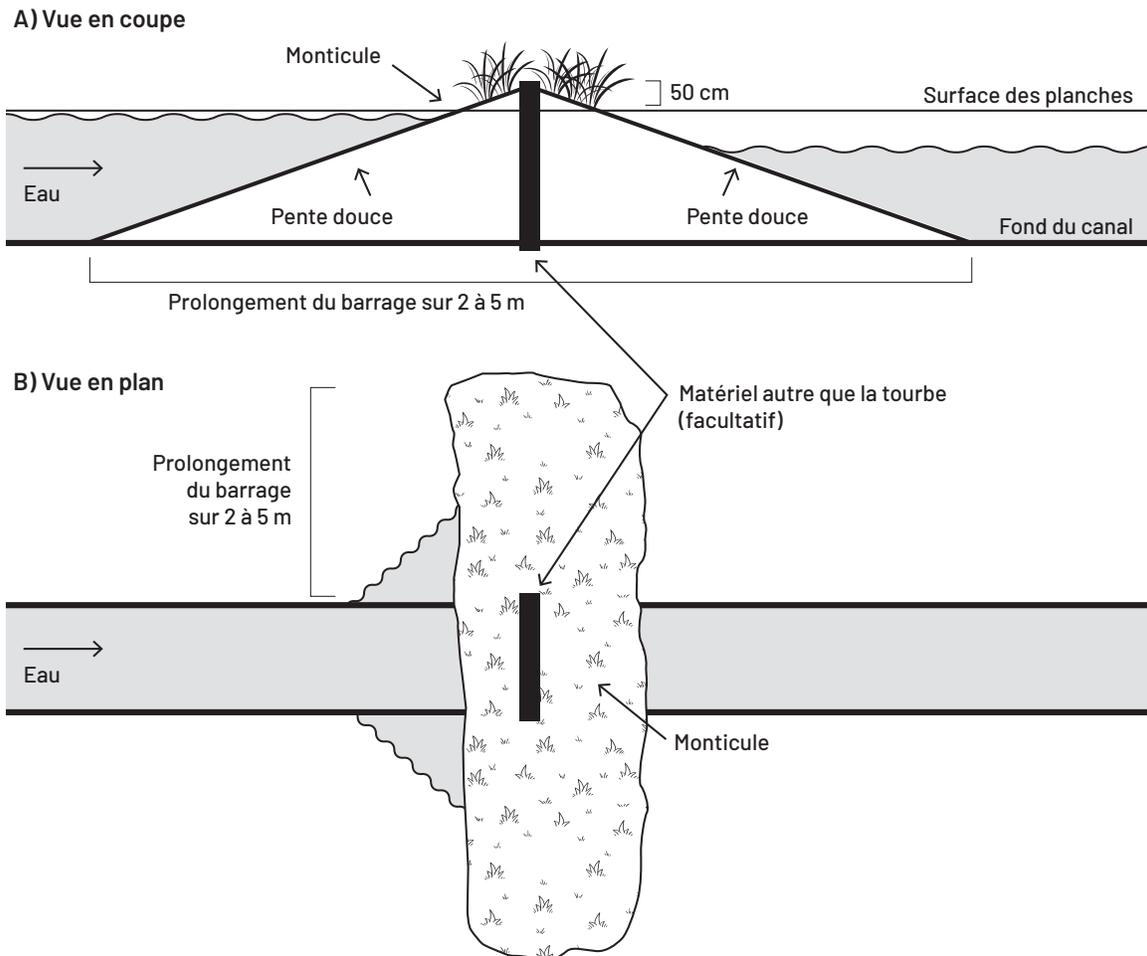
Croquis illustrant un barrage dans un fossé de drainage secondaire en coupe (A) et en plan (B).
